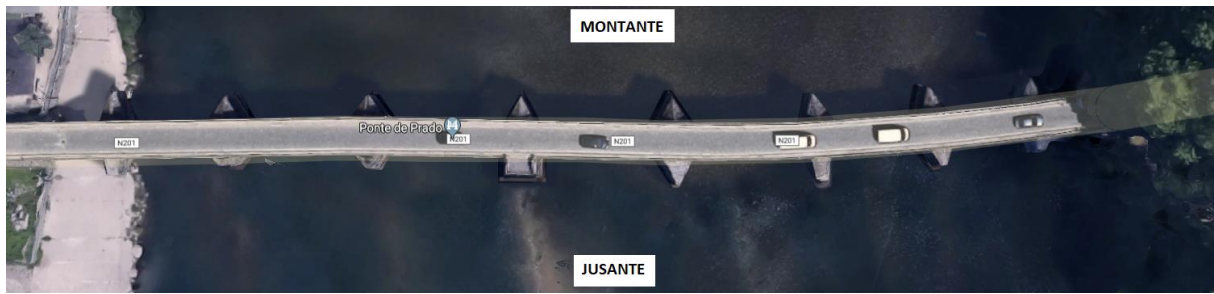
Representação esquemática da vista aérea da Ponte - planta
